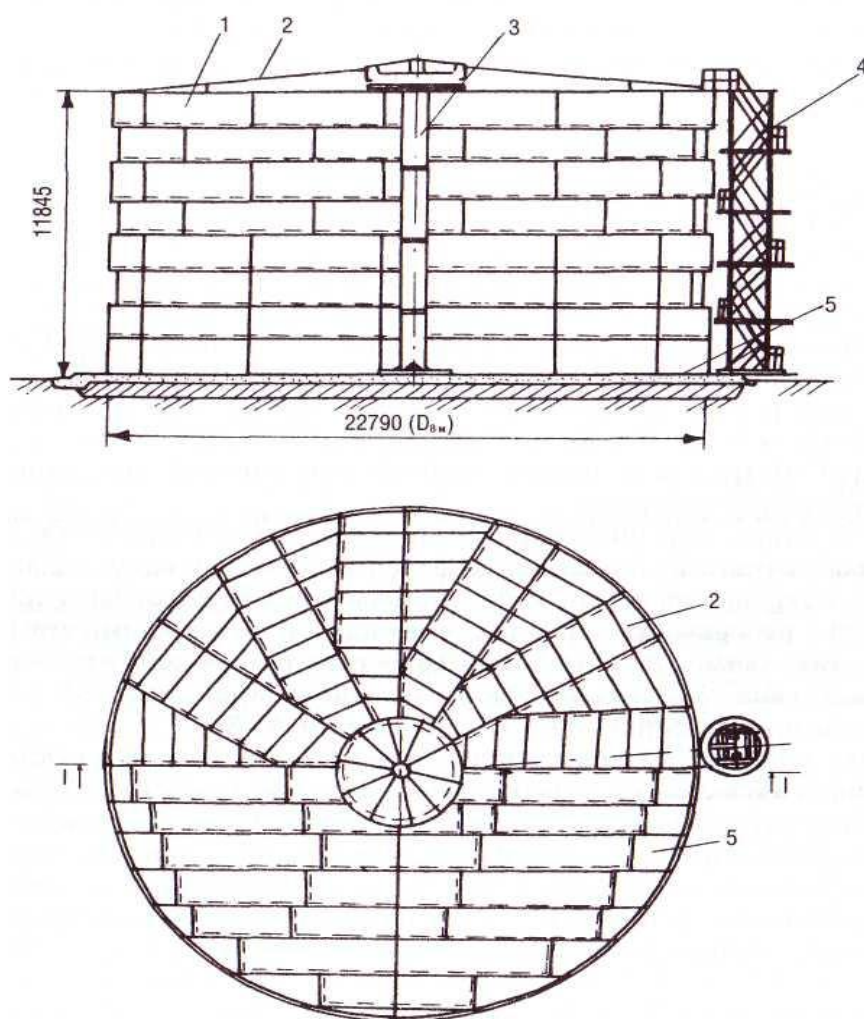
Вертикальный цилиндрический резервуар объемом. 5000 куб. м со щитовой кровлей:
